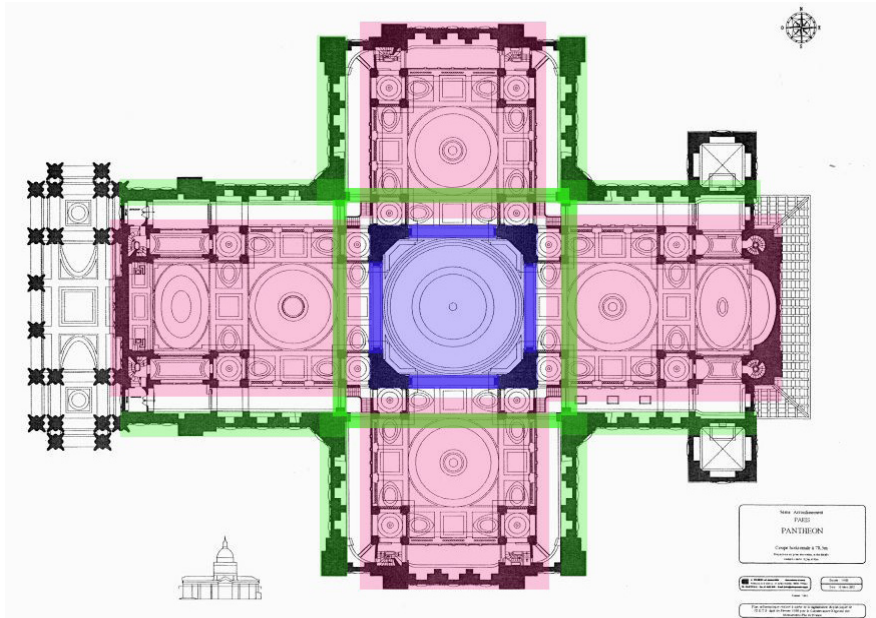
Pianta e sezione longitudinale dei sistemi strutturali del Panthéon: In blu il sistema dei pilastri e delle cupole; in verde il sistema dei grands arcs e dei muri perimetrali; in rosa il sistema delle colonne e dei plafonds³.
